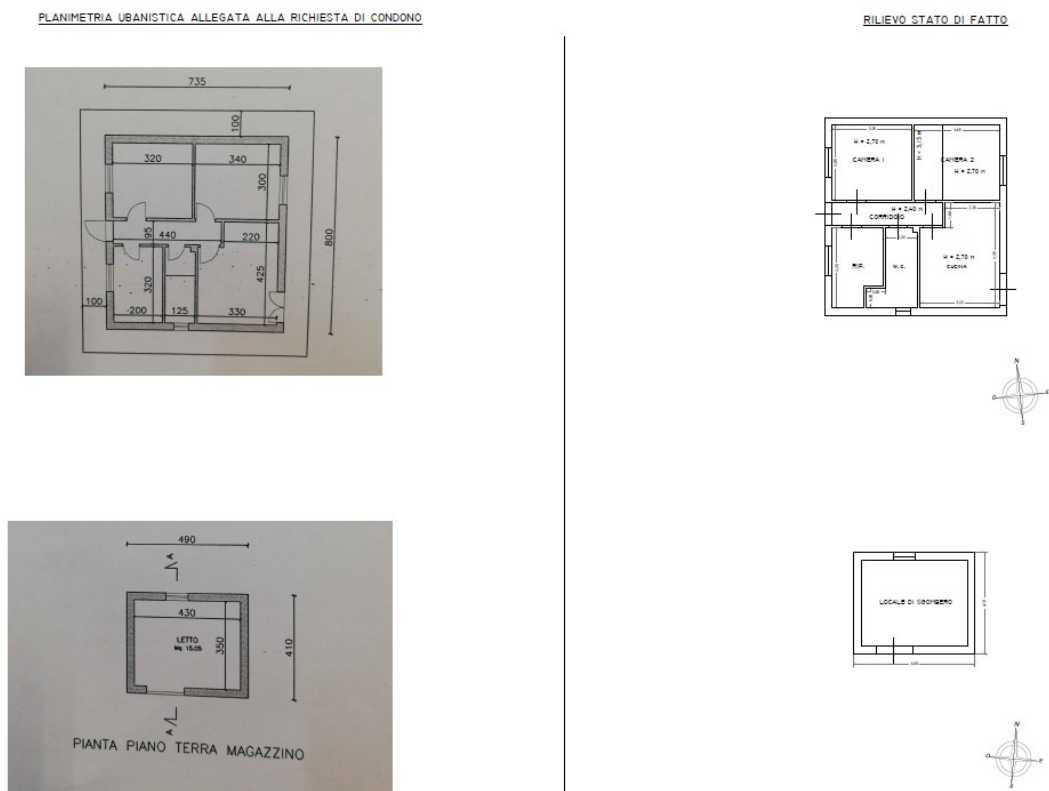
CONFRONTO PLANIMETRIA ALLEGATA ALL’ISTANZA DI CONDONO CON STATO DEI LUOGHI
